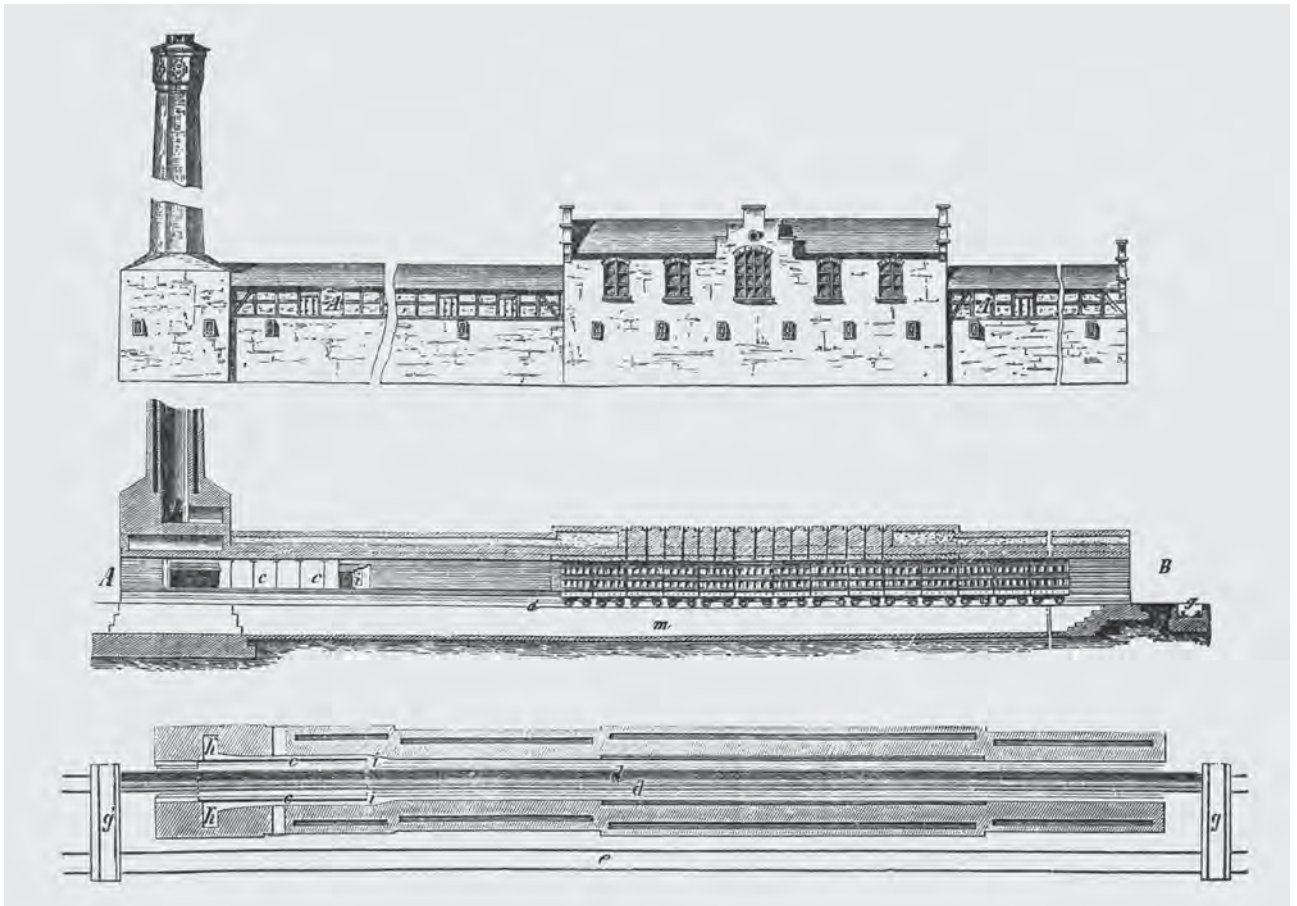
Tunnelofen von Bock, 1874, Außenansicht, Längsschnitt und Grundriß
